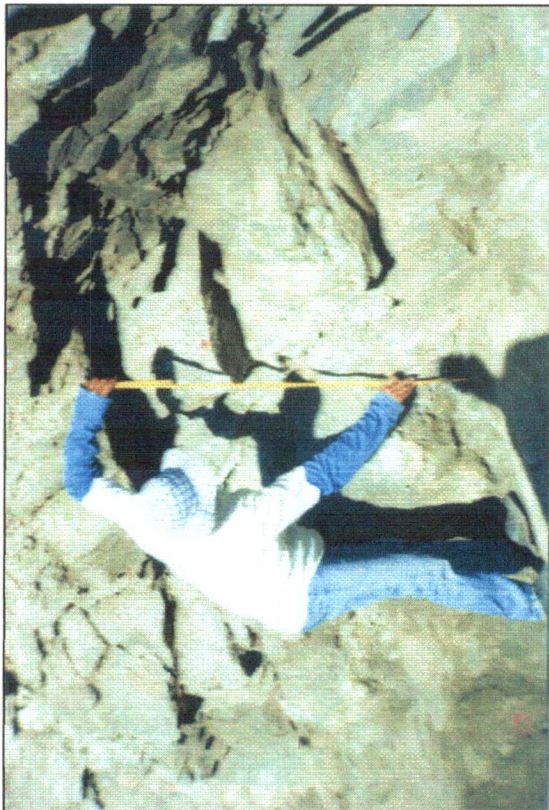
Medição do local para fixação do muro de contenção.
